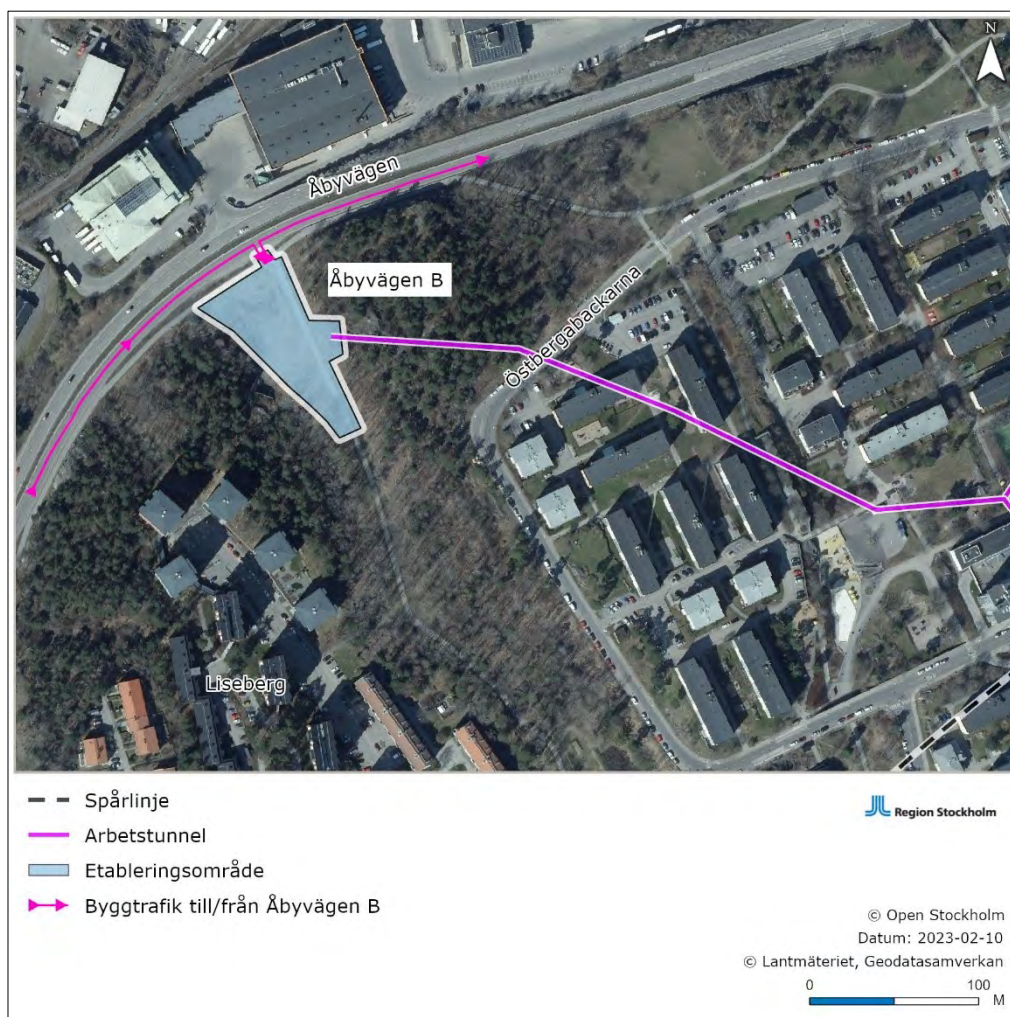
Studerade arbetstunnlar och tillhörande etableringsytor för station Årstafältet. Spårlinje och arbetstunnlarnas sträckning är ungefärliga.
